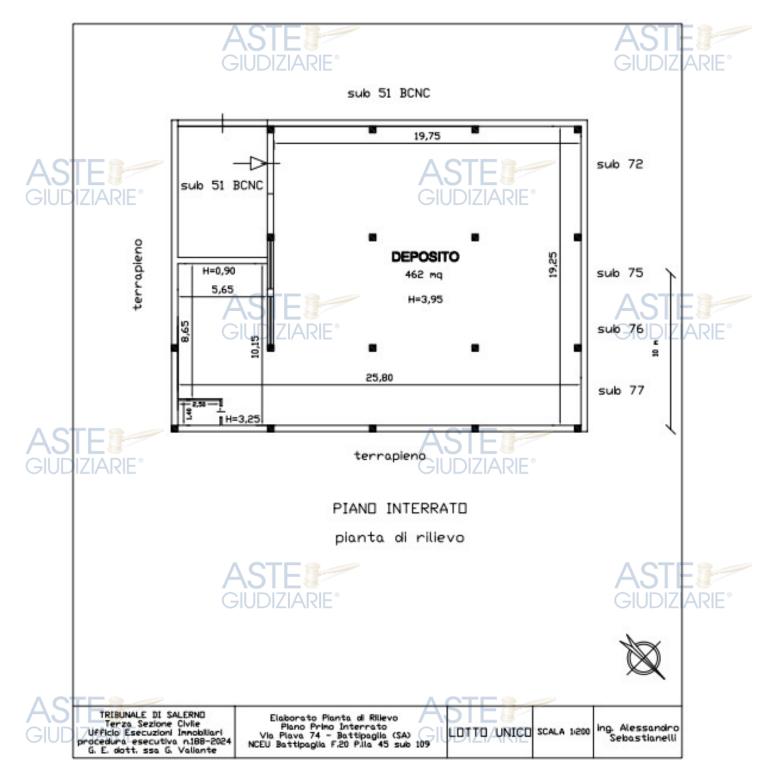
Planimetria stato di rilievo deposito piano interrato compendio pignorato
